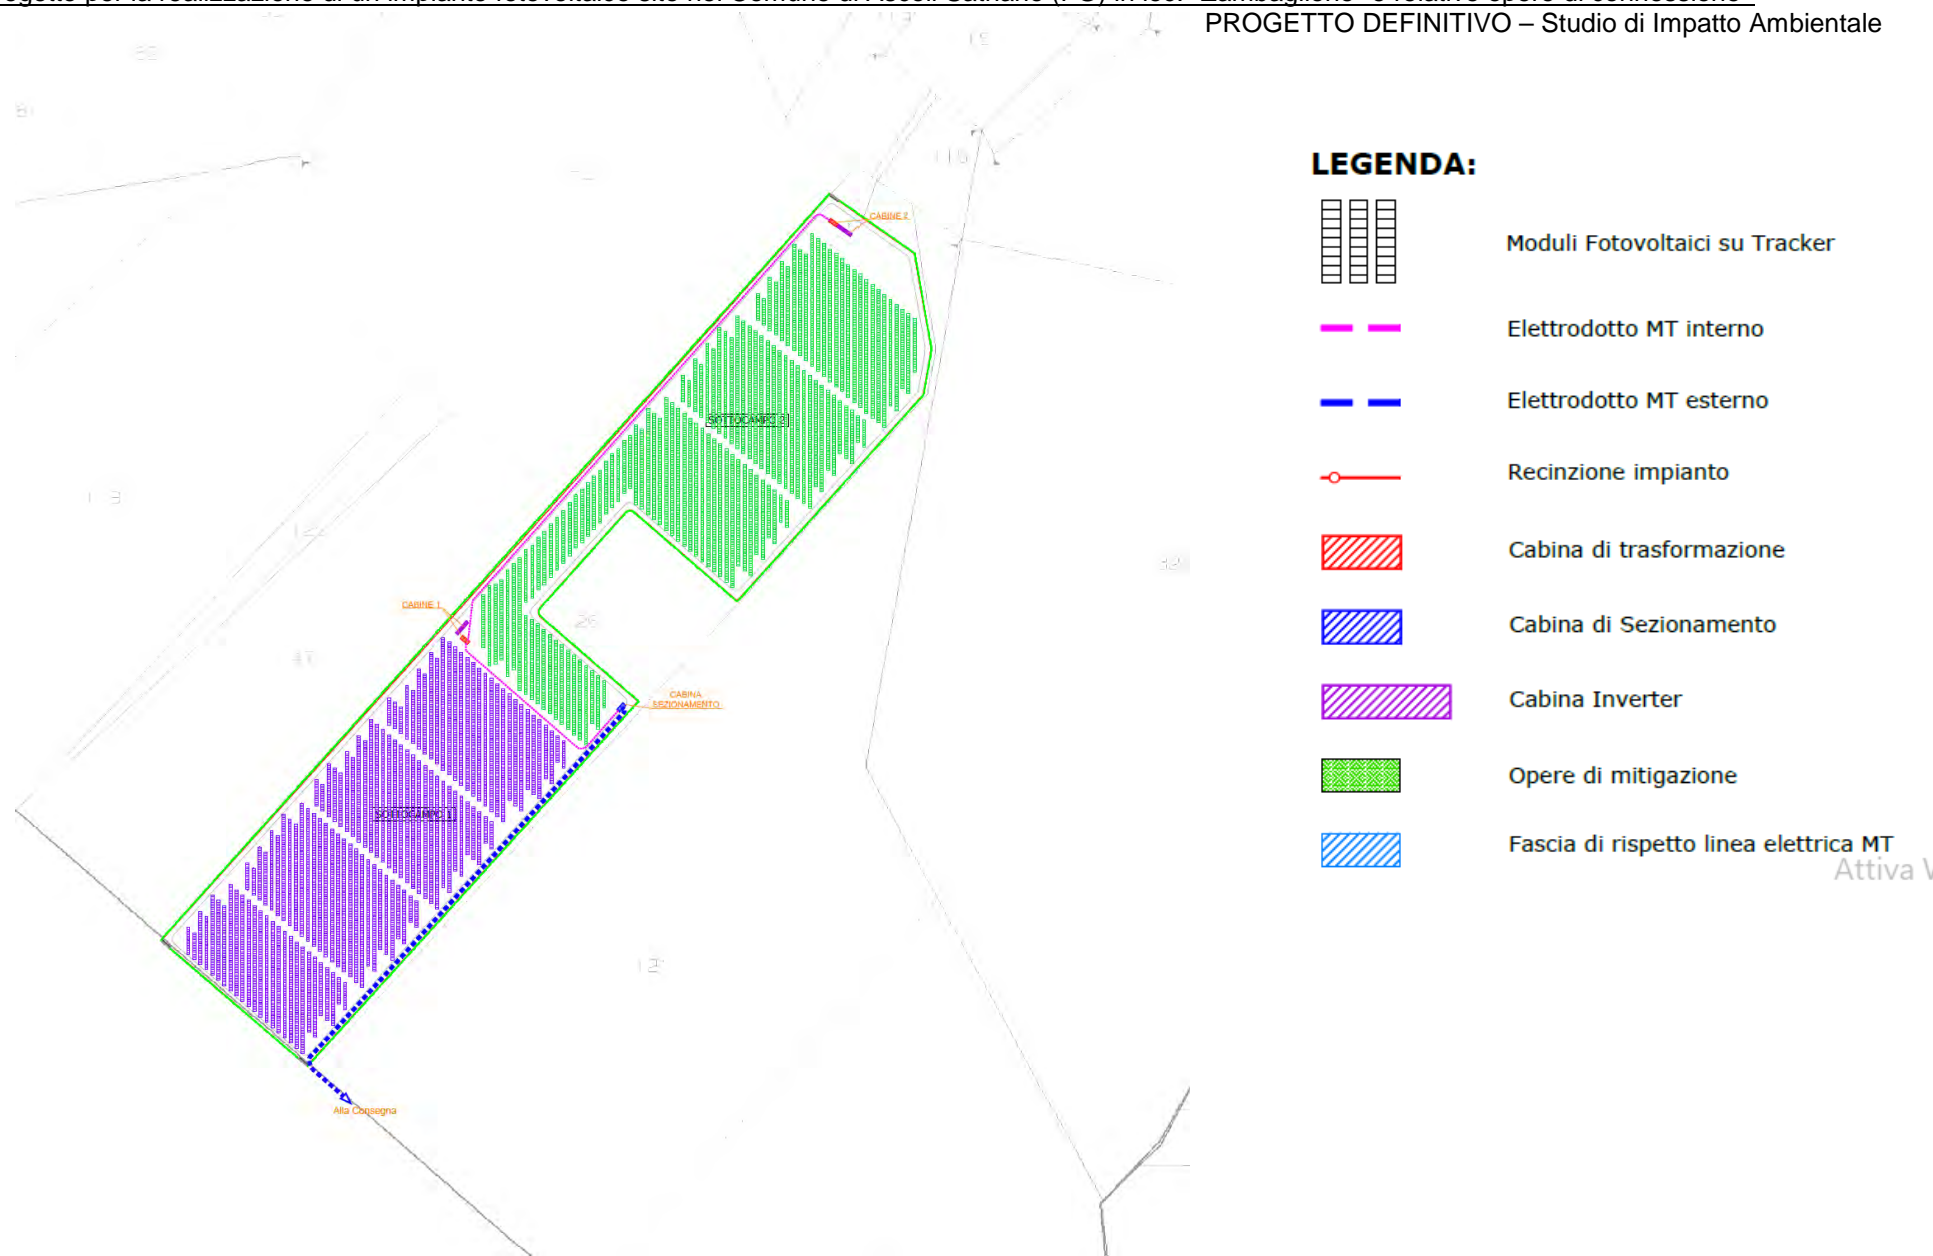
Stralcio elaborato DEF-TAV.07A – Layout impianto con sottocampi
